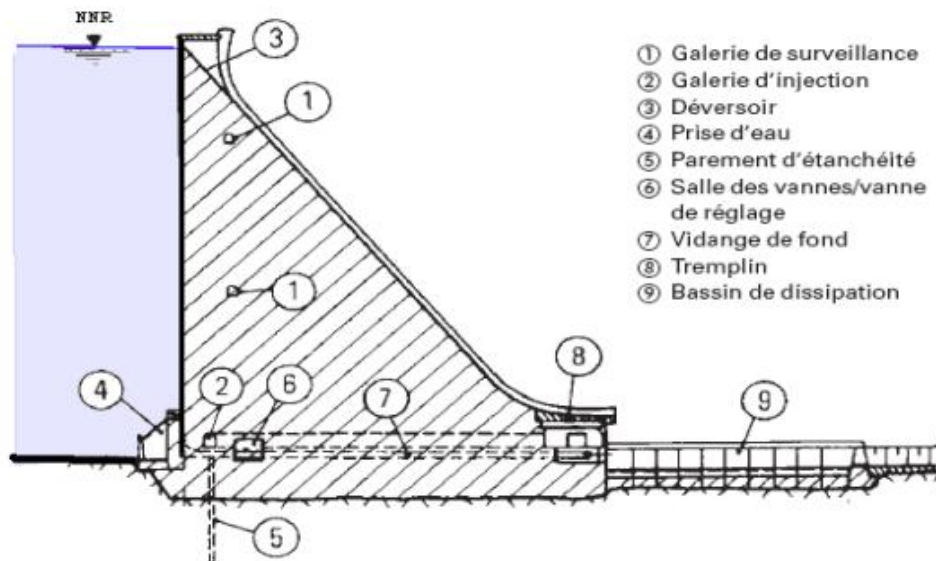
Coupe transversale d'un barrage poids [1]
